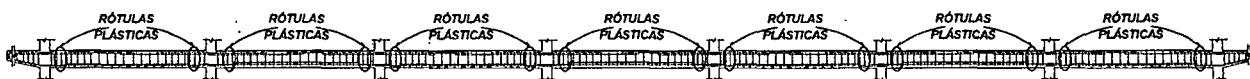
Ubicación de las rótulas a analizar en las vigas V-104, V-204, V-105 y V-205
